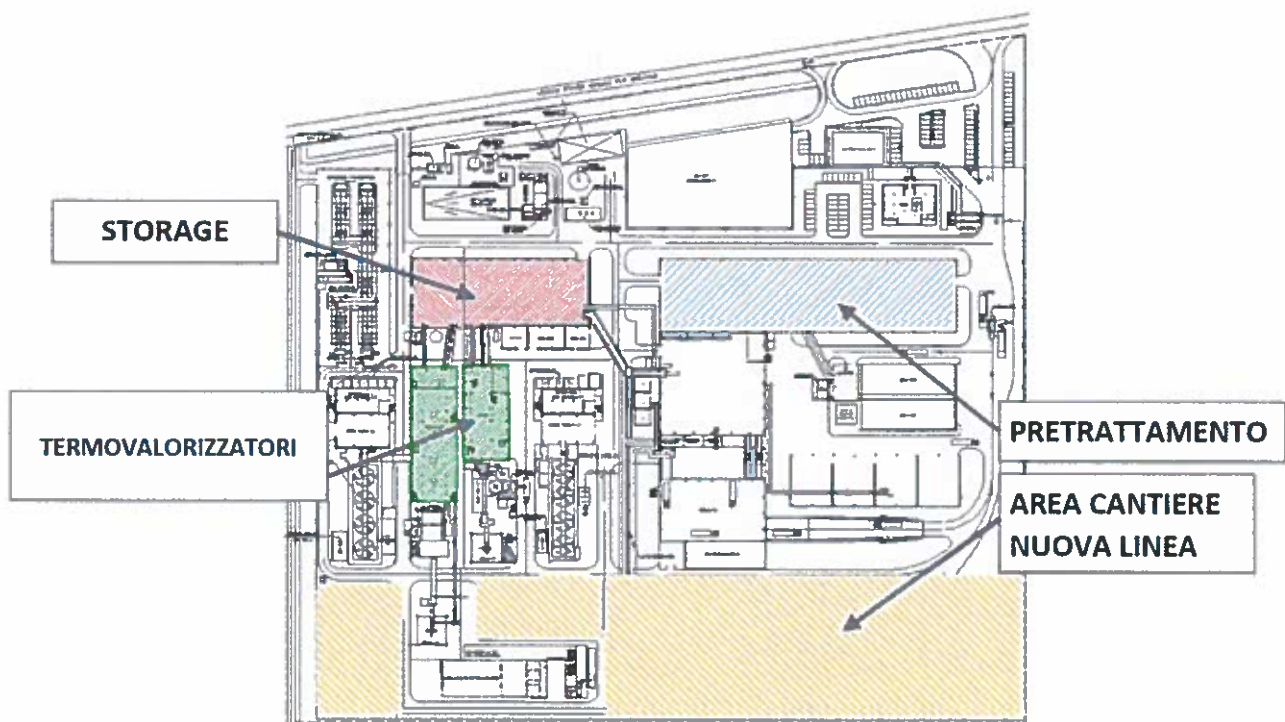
PLANIMETRIA GENERALE DELLO STABILIMENTO
